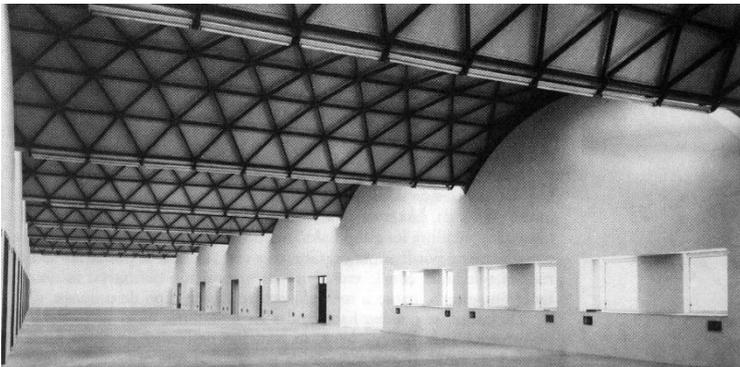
Cubierta laminar metálica Nave de Talleres / *Steel shell roof of the workshops
